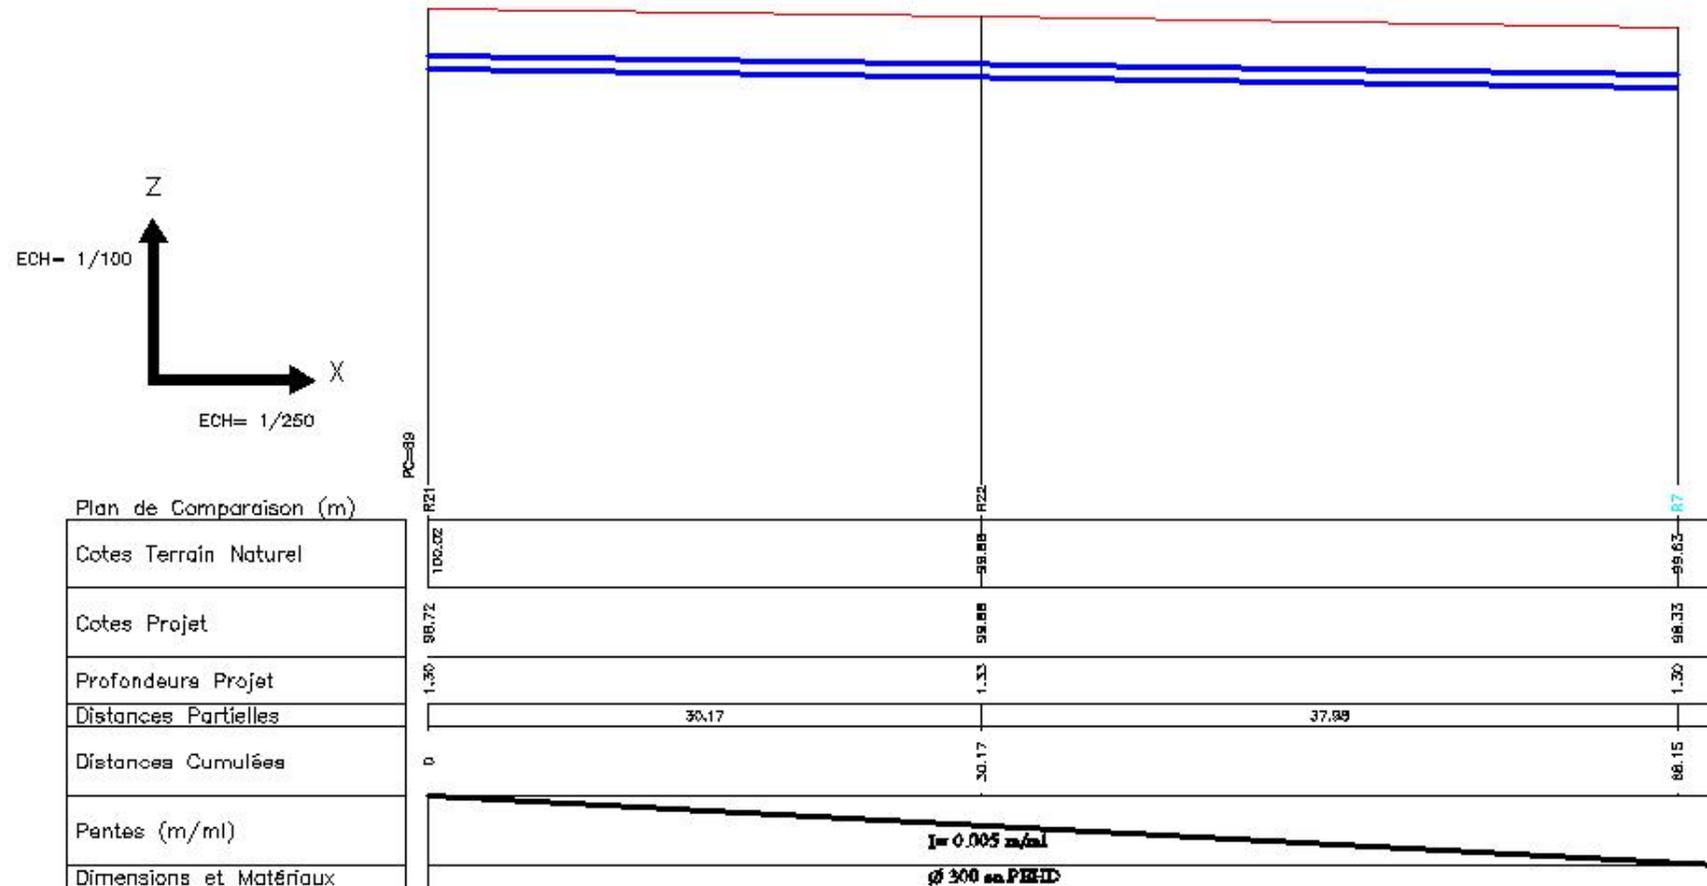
Profil en long du Collecteur : A-2 dessiné sur Auto CAD
